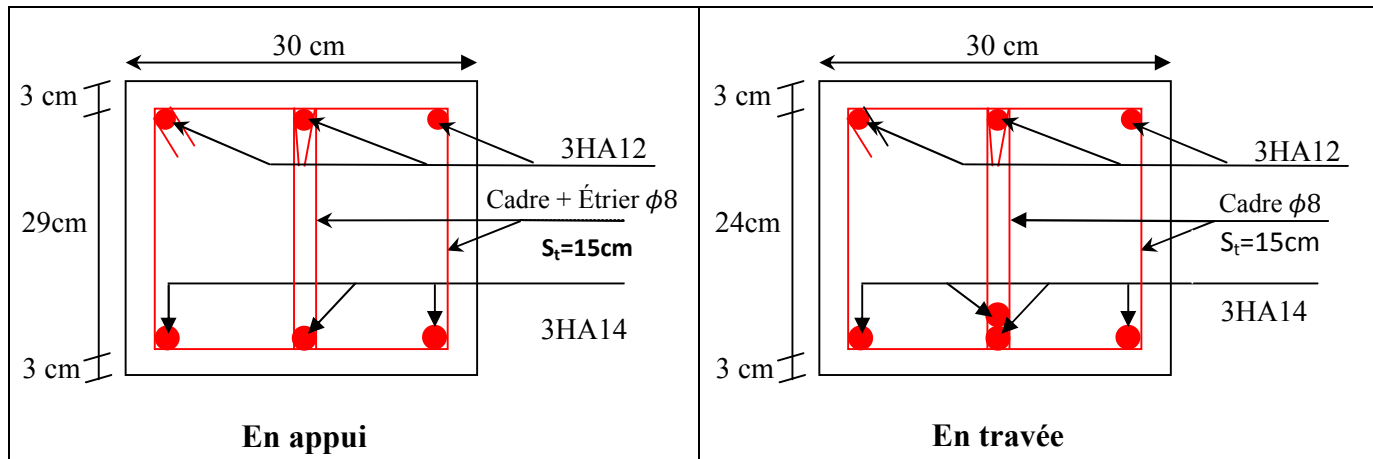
Schéma de ferrailage de la poutre de chaînage
